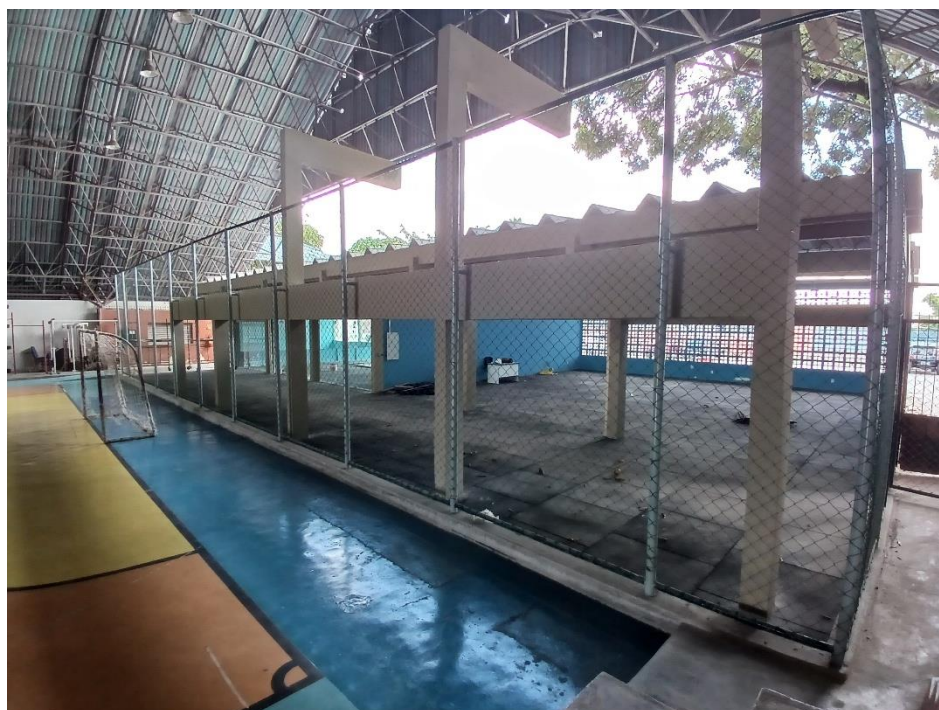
Academia SEGEL: fachada sudoeste pós-obra. Fonte: Acervo do autor (2024)
